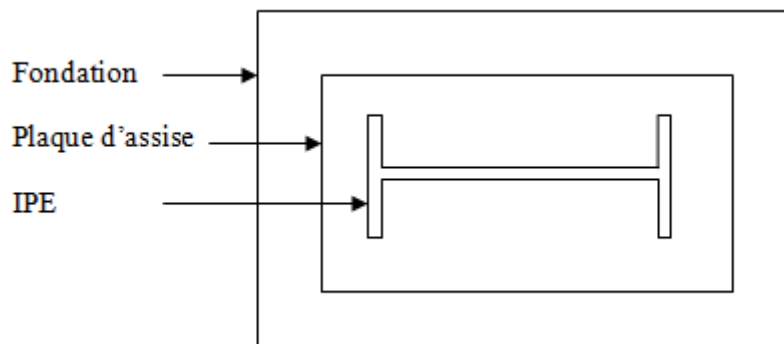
Vue en plan d'un assemblage du pied de poteau.
